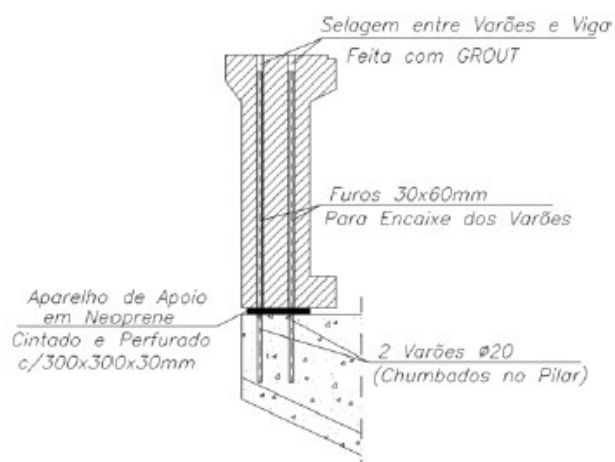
Secção transversal na ligação viga-pilar [14].
